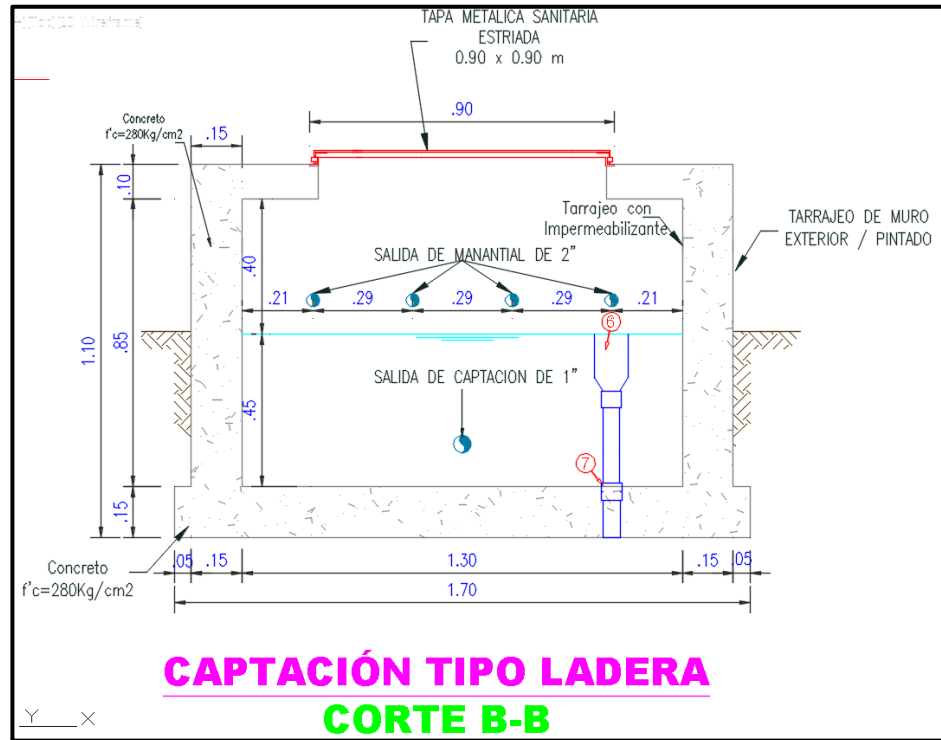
Planteamiento de Captación Tipo Ladera Corte B-B
